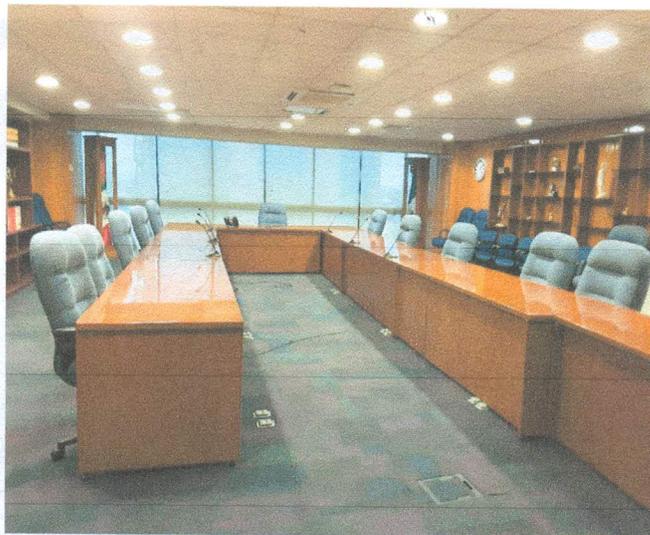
En esta sala de juntas no se encontraron grietas ni fisura alguna
